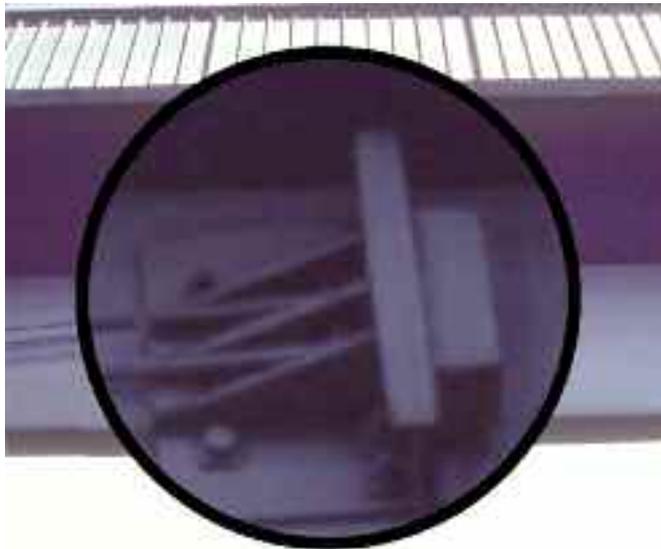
bossage d'ancrage métallique sur une passerelle de l'autoroute A 15 (crédit photo D. Poineau)
